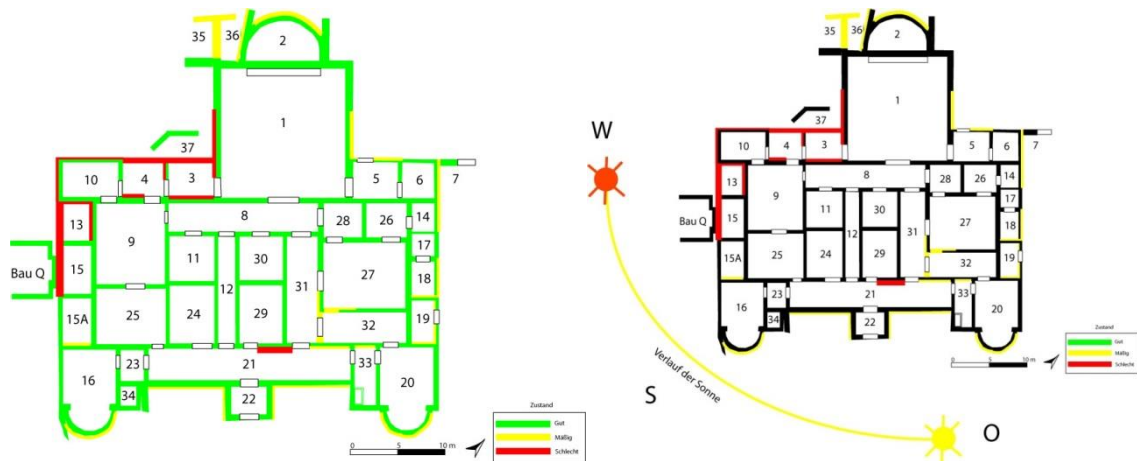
Grundrissplan mit kartiertem Zustand der Palastmauern.
